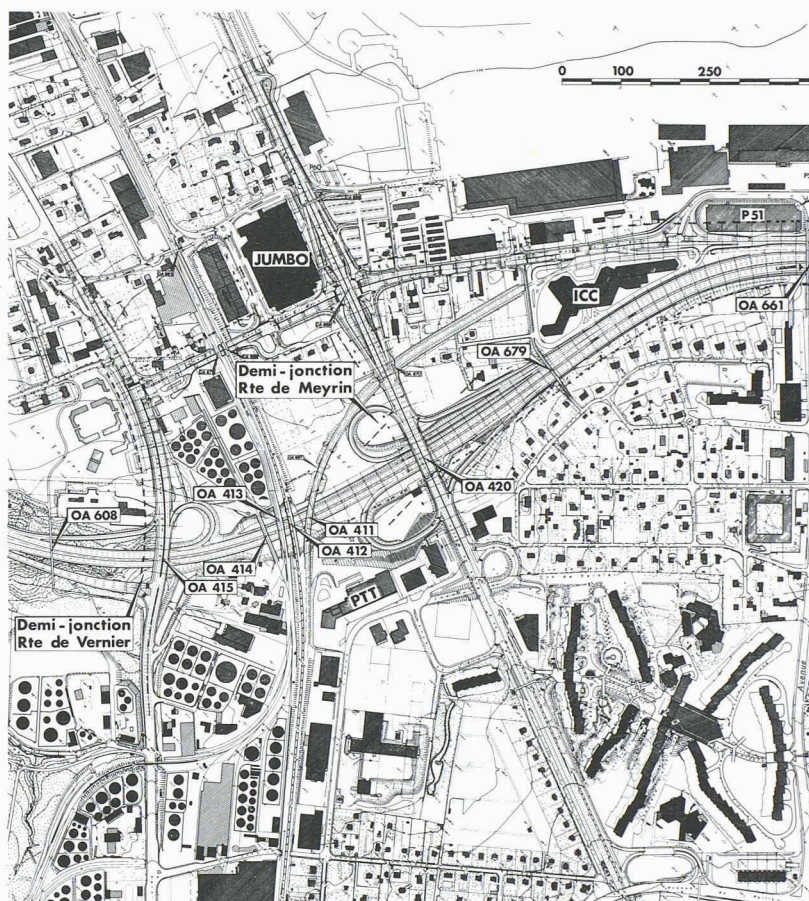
L'autoroute de contournement de Genève: plan de la section 7
